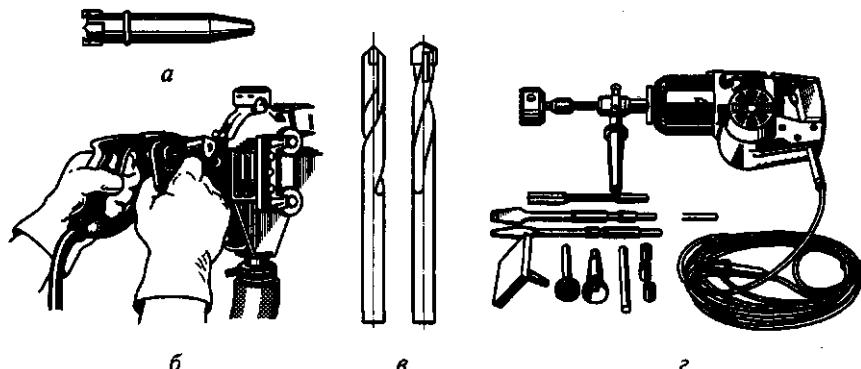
Инструмент, механизмы и приспособления для пробивных работ:
